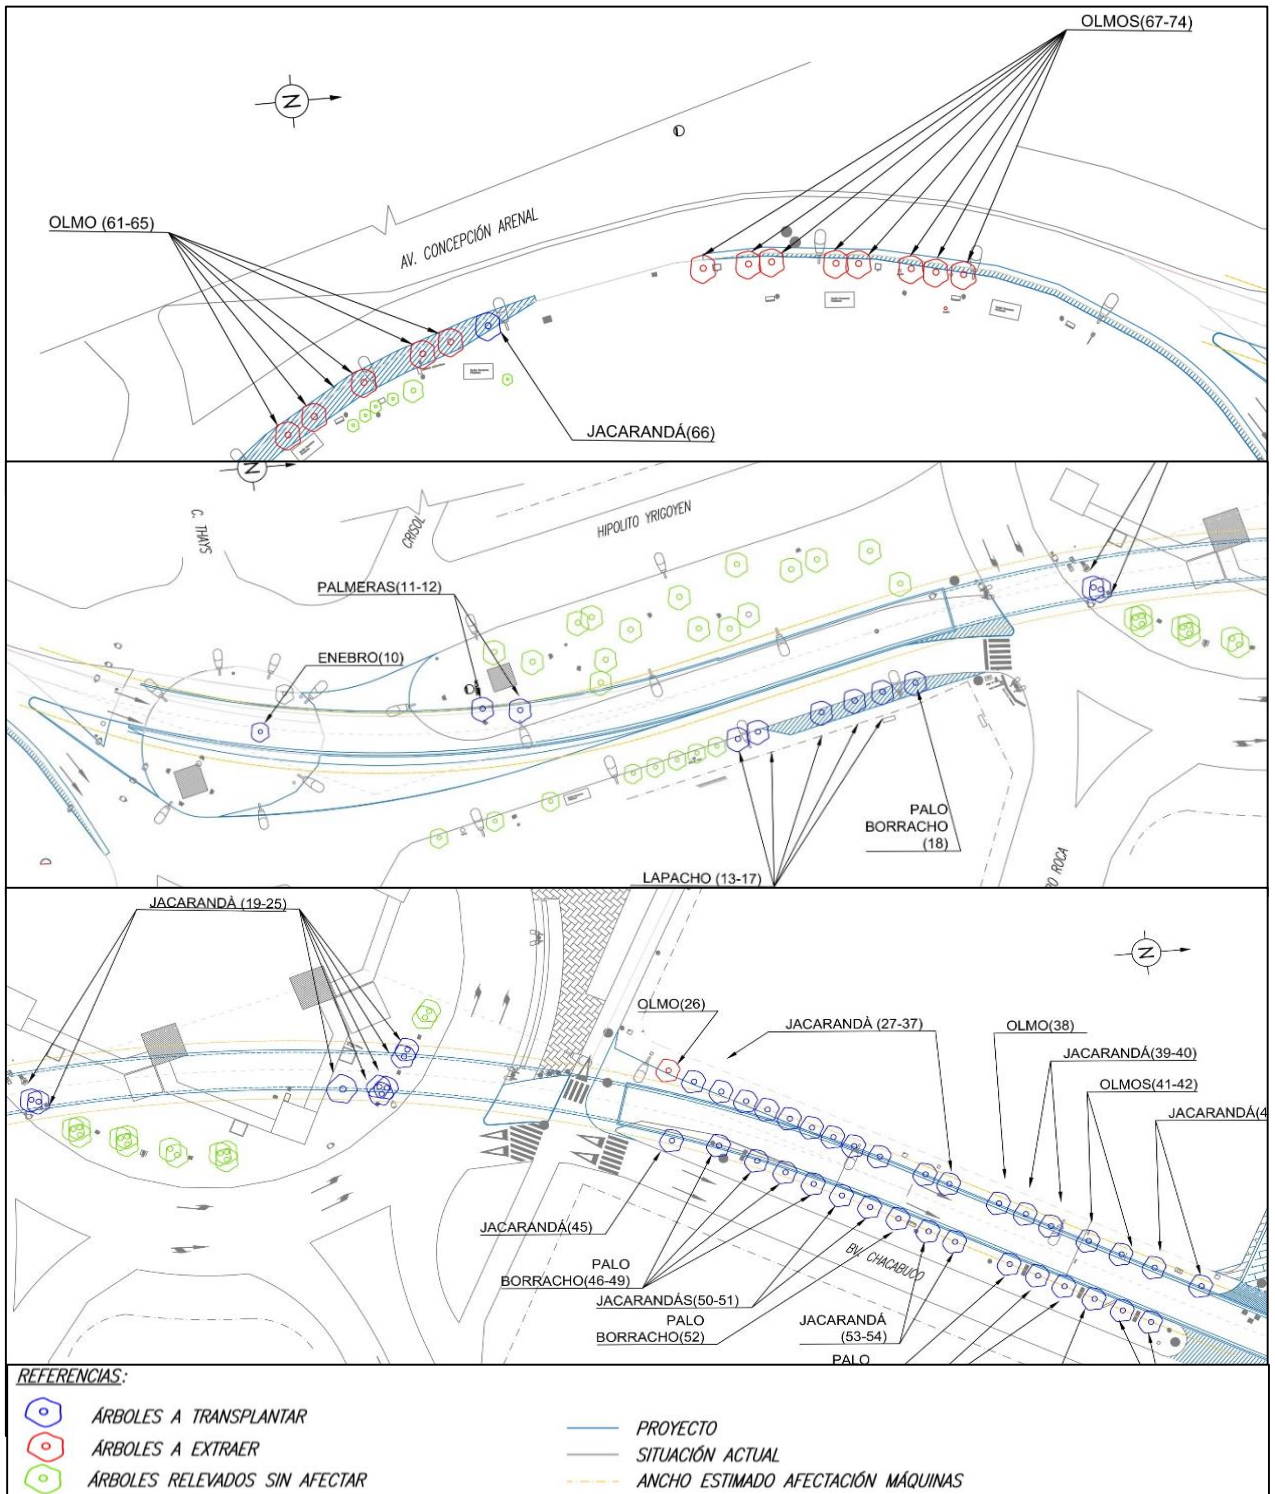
Planimetría general con árboles a transportar y extraer (PLANO N° 10)
